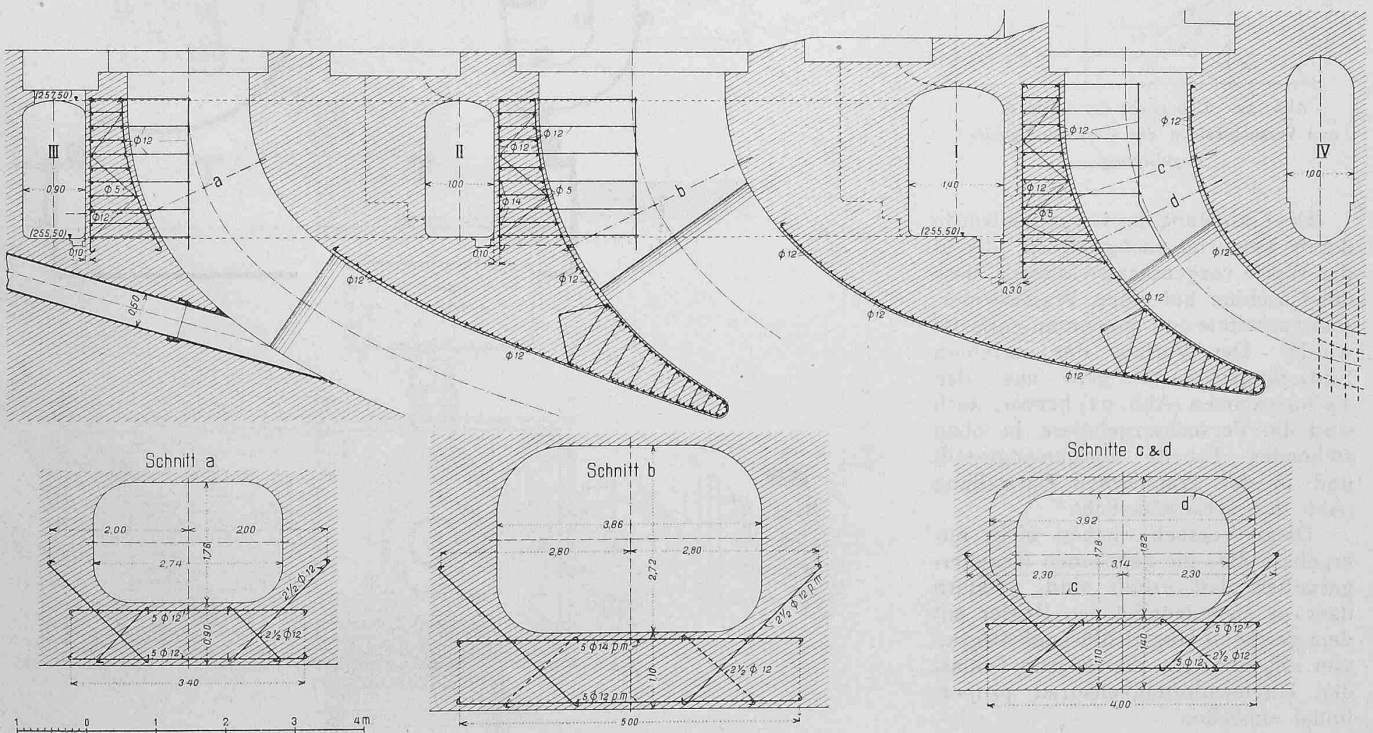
Betonierte und eisenarmierte Turbinen-Saugrohre des Kraftwerks Wyhlen. — Masstab 1 : 100.
